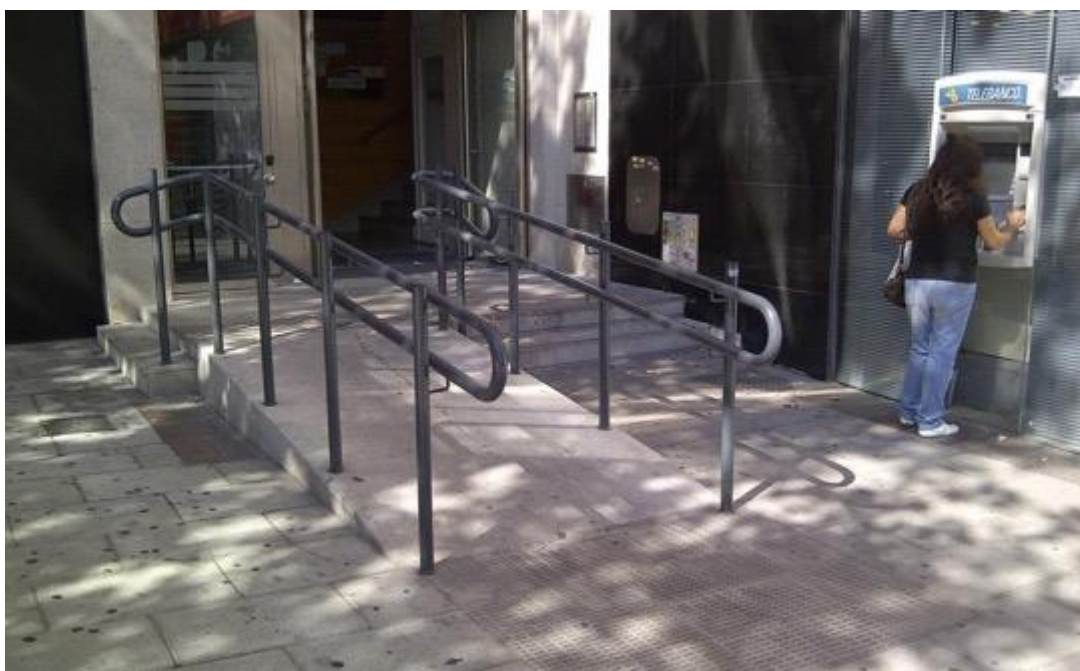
Rampa de acceso a edificios. Calle Bravo Murillo. En su ubicación en la vía pública esta rampa respeta el entorno en el que se construye, manteniendo la servidumbre en la fachada colindante generada por el cajero automático y complementando su recorrido con la posibilidad de salvar el desnivel mediante una escalera. Pasamanos continuo a doble altura y pavimento tacto visual en su inicio complementan el trazado accesible que genera hasta el portal del edificio
